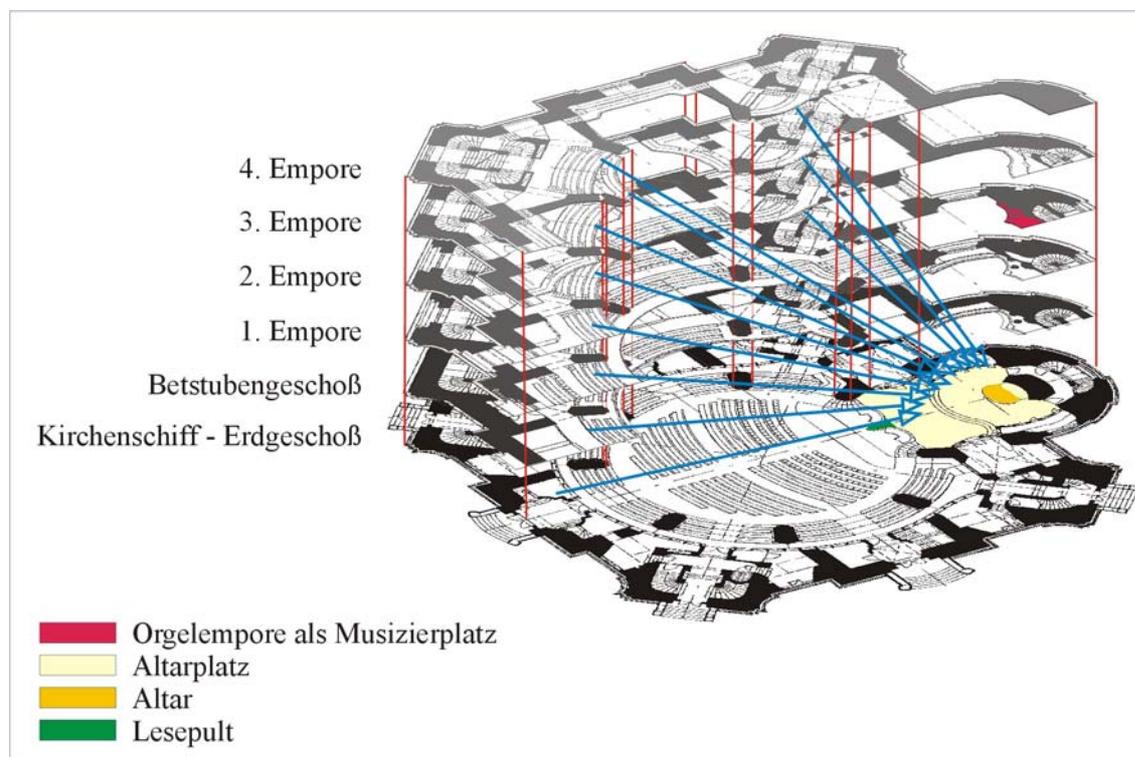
In der Bauaufgabe für die dresdner Frauenkirche geforderte Sichtbeziehungen zu Altarplatz, Kanzel und Orgelempore. Dargestellt anhand der Grundrisse der einzelnen Geschosse des letztendlich ausgeführten Baus.<sup>24</sup>
